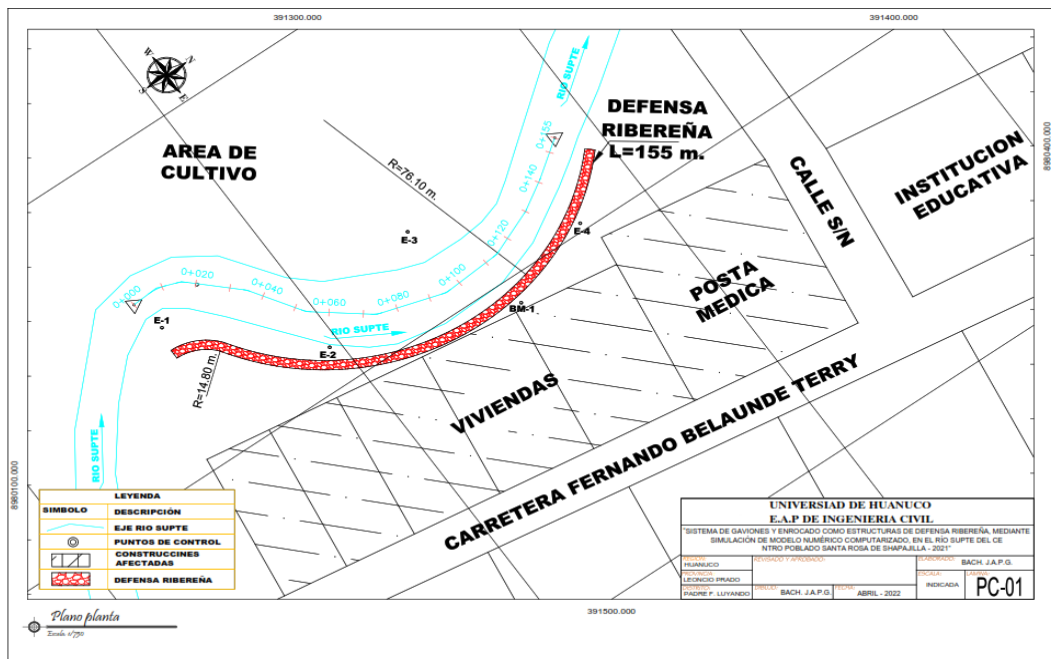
Vista en planta para el sistema de defensa con gaviones.
